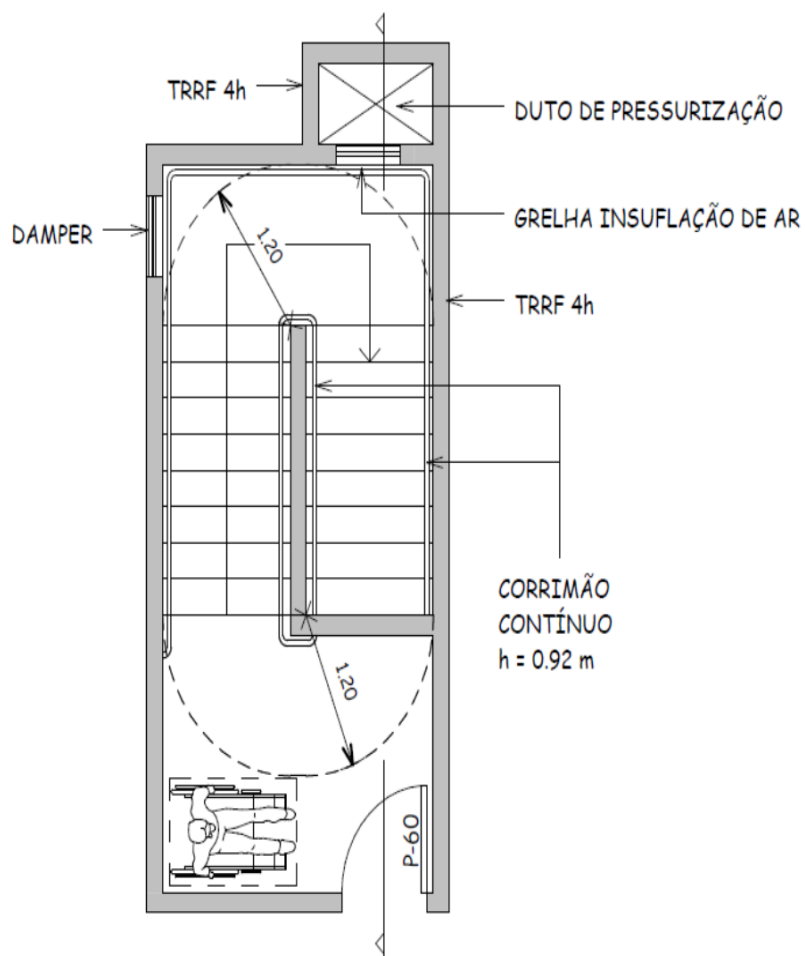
C - Escada à prova de fumaça pressurizada - pavimento intermediário com damper (planta baixa).
